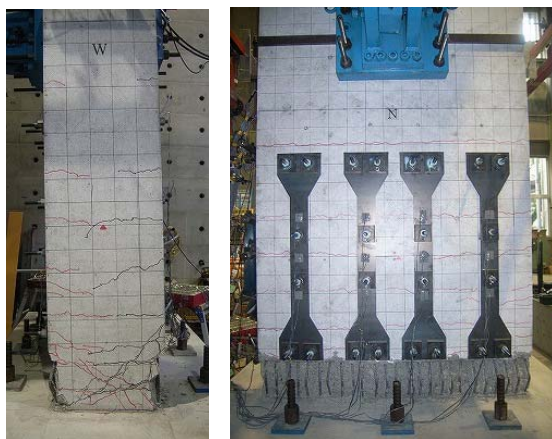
No. 3 供試体の損傷状況 (10 δ 時)
